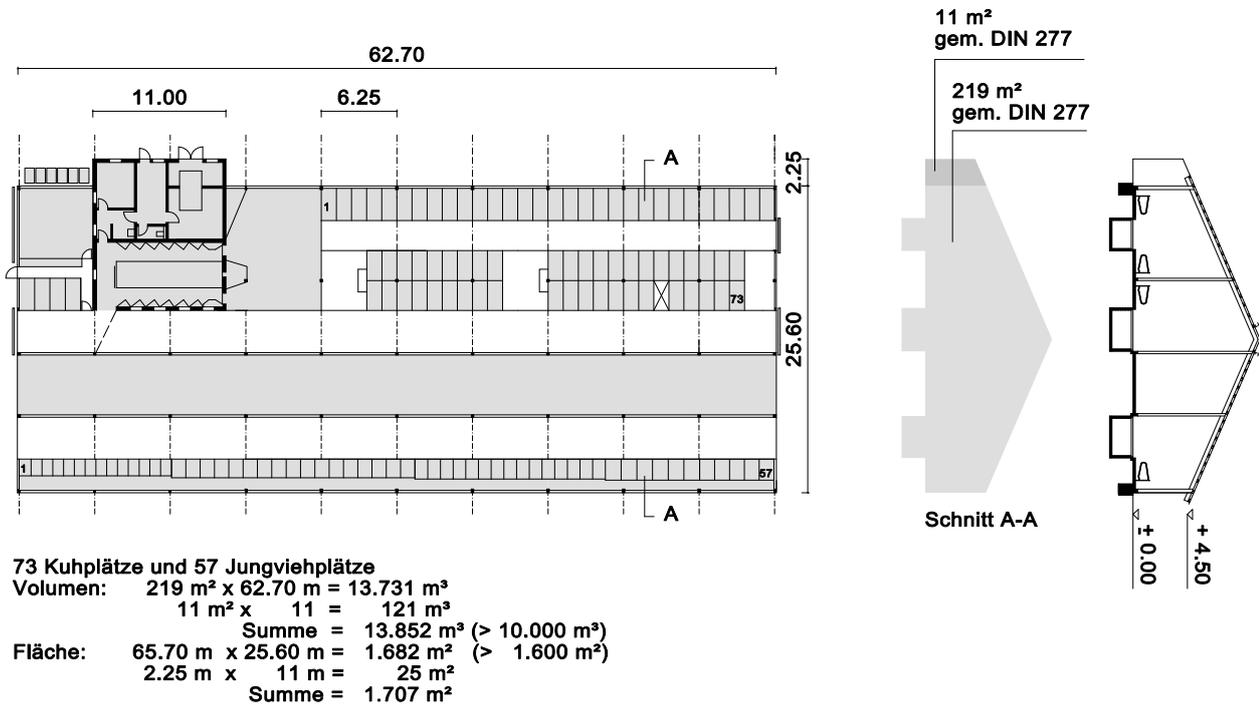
Flächen- und Volumenermittlung für einen Milchviehstall (mit eigener Nachzucht) und integriertem Melkhaus
